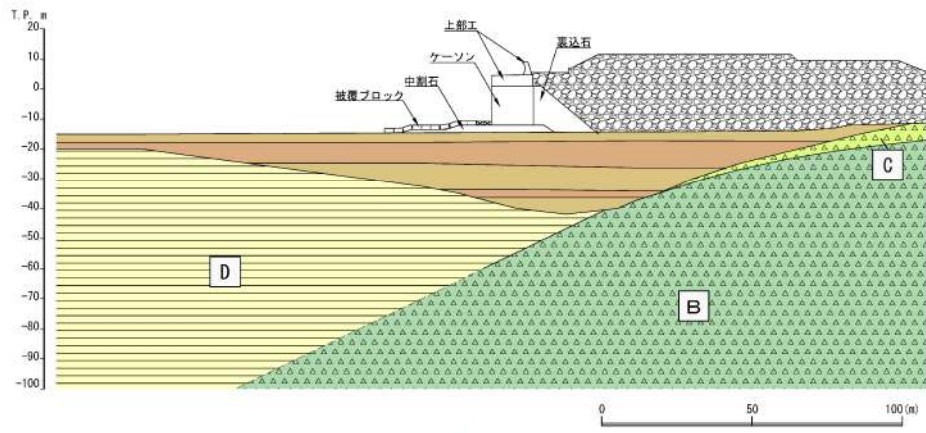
c.b-14 地質断面図 (F-F' 断面)
